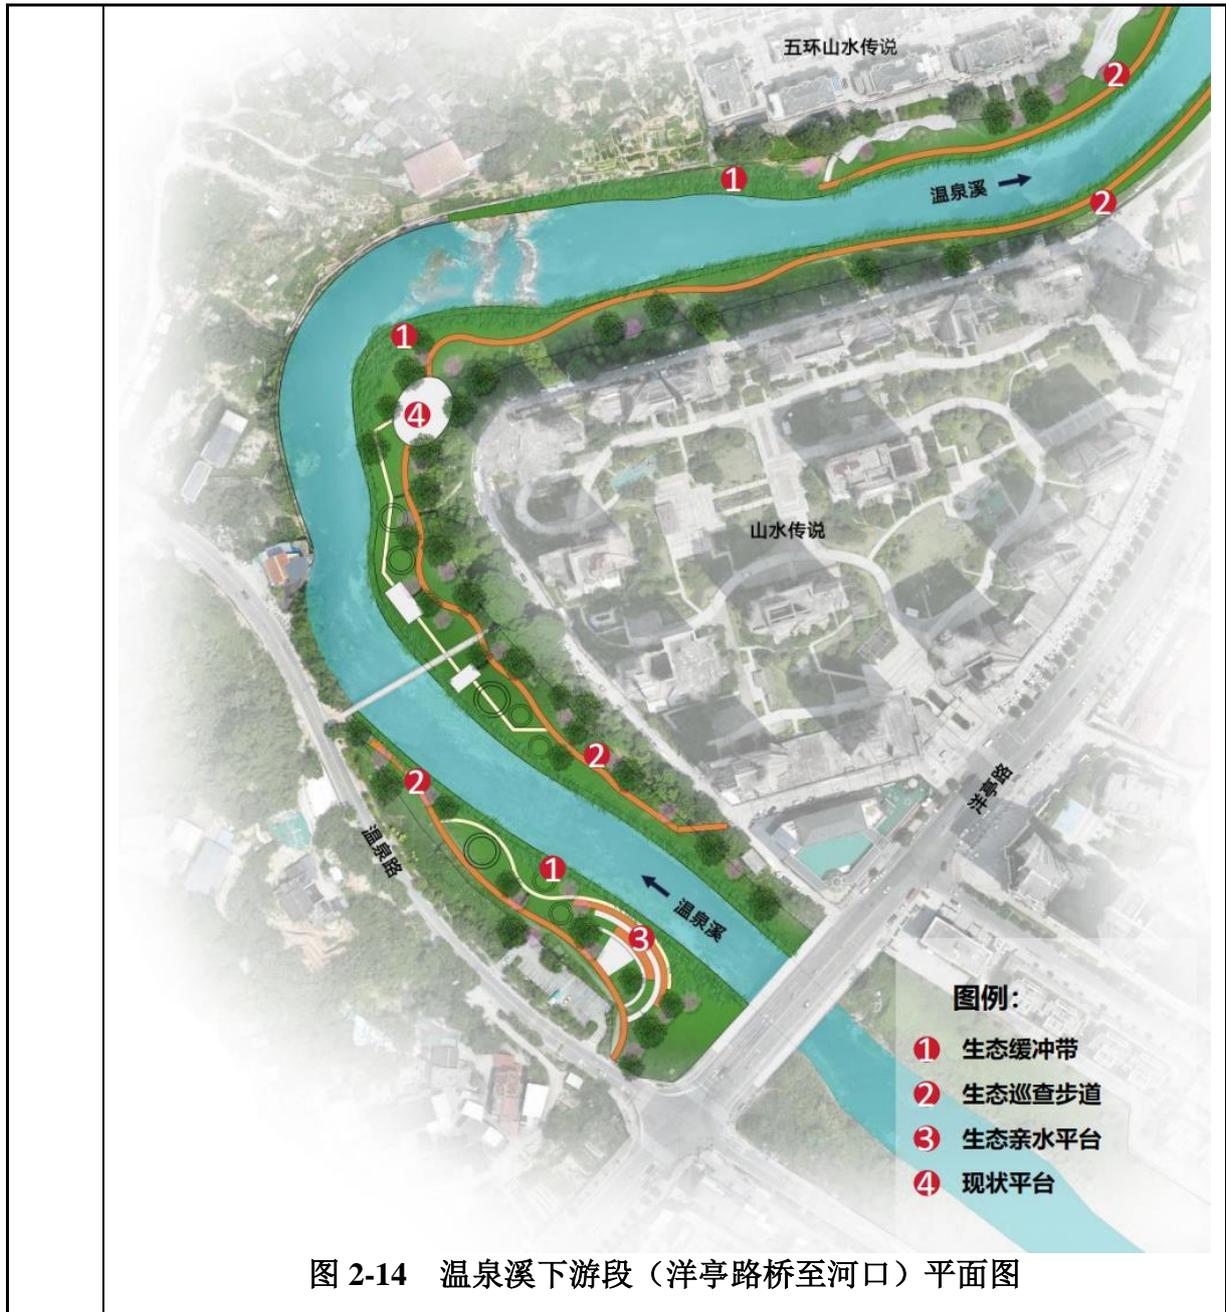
温泉溪下游段（洋亭路桥至河口）平面图
